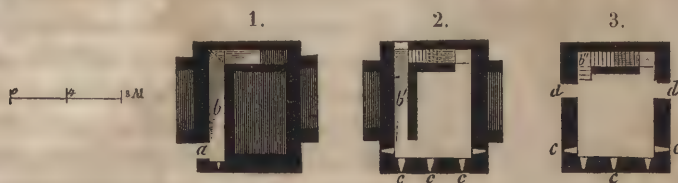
Grundriss der Thürme in drei Geschossen.
